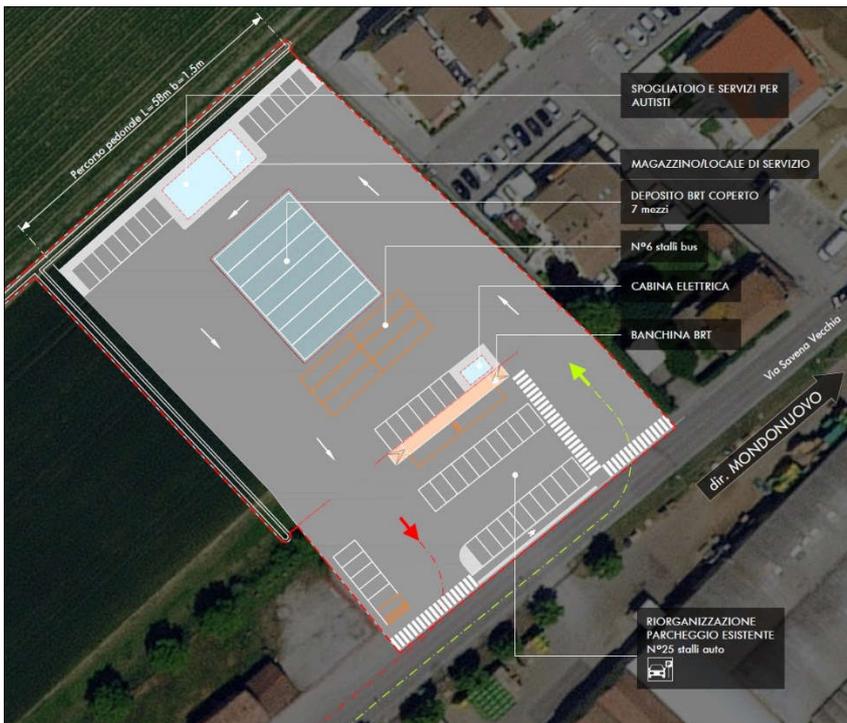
Capolinea e deposito di Baricella. Planimetria.
